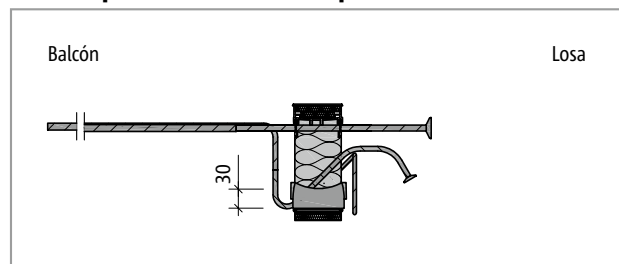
Schöck Isokorb® T tipo K-U-M4: Sección del producto
